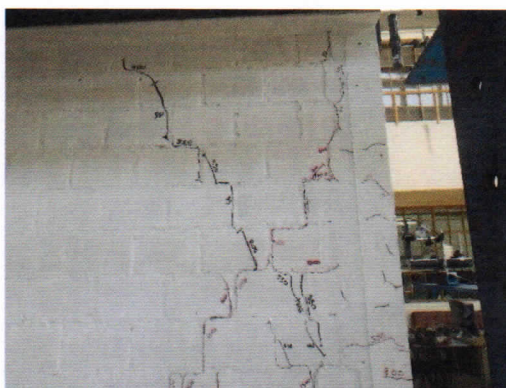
Continuación de grietas diagonales en el lado Este de la cara Sur para una distorsión de 1/400.
